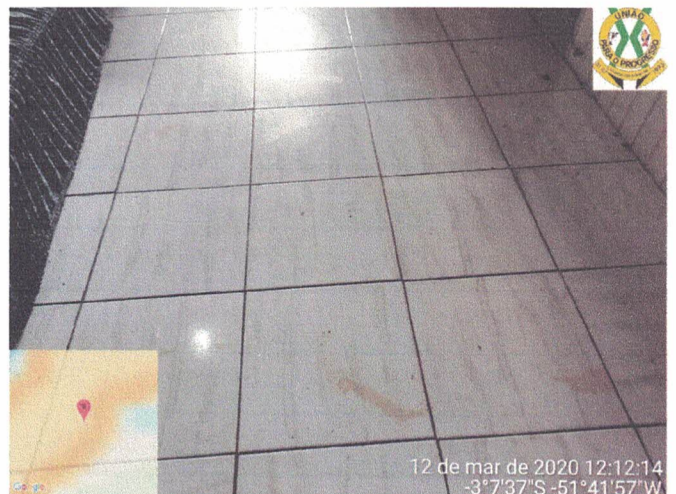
a 1.11 – Banheiro e Caixa d'água.
